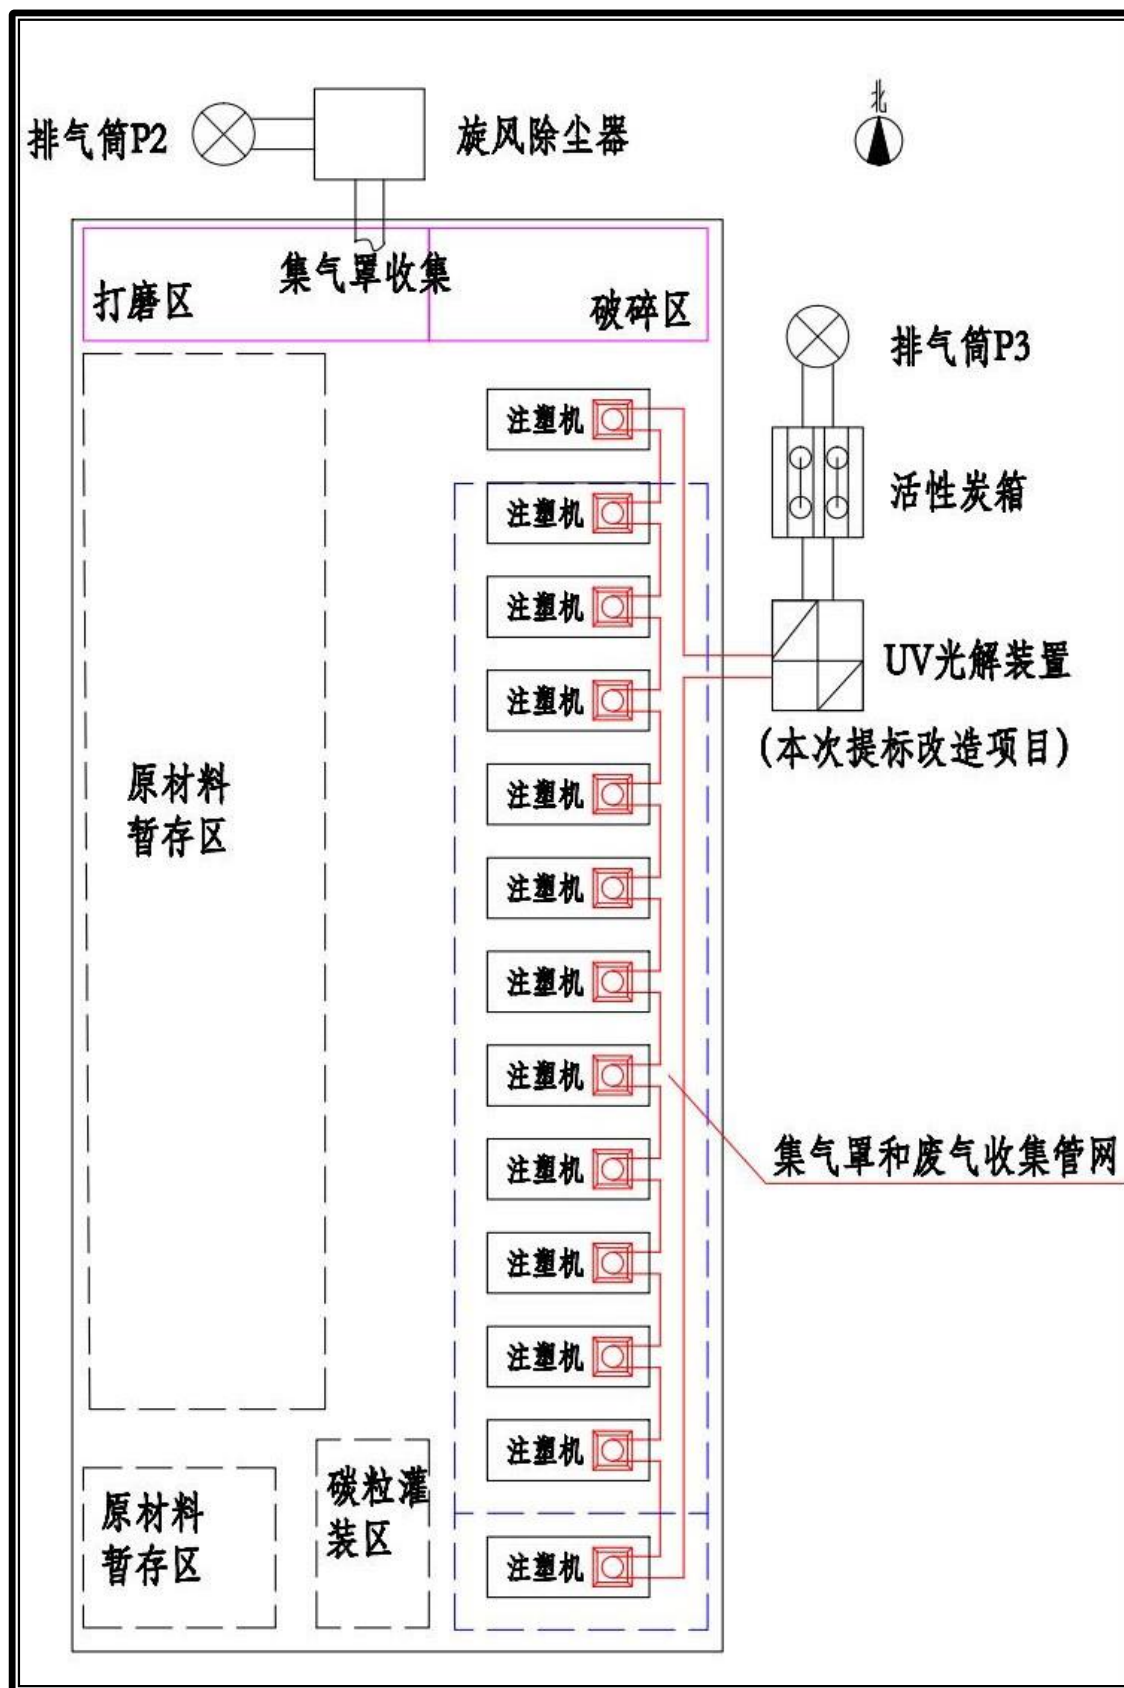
1#厂房平面布置图及注塑区废气收集管线图
